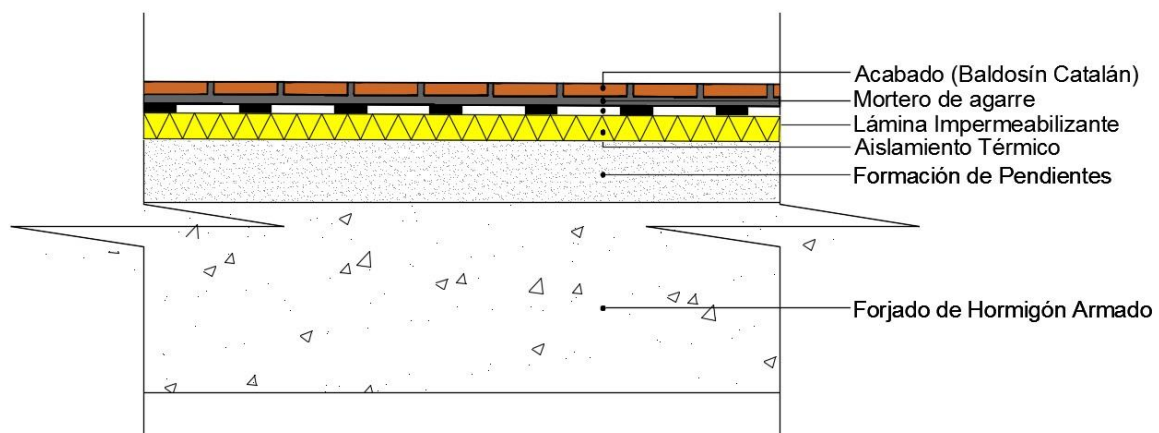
Sección constructiva del cerramiento de la cubierta principal del edificio con la introducción de la capa de aislamiento
